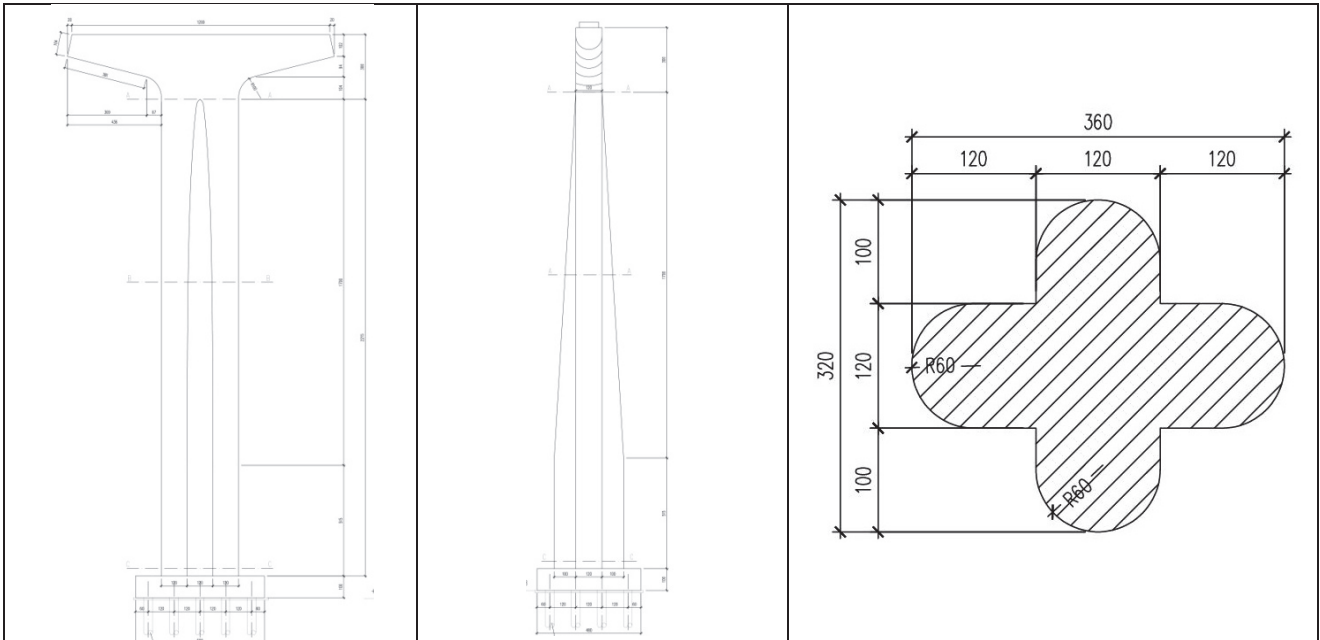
Pila 1: vista trasversale e longitudinale, sezione trasversale di base
